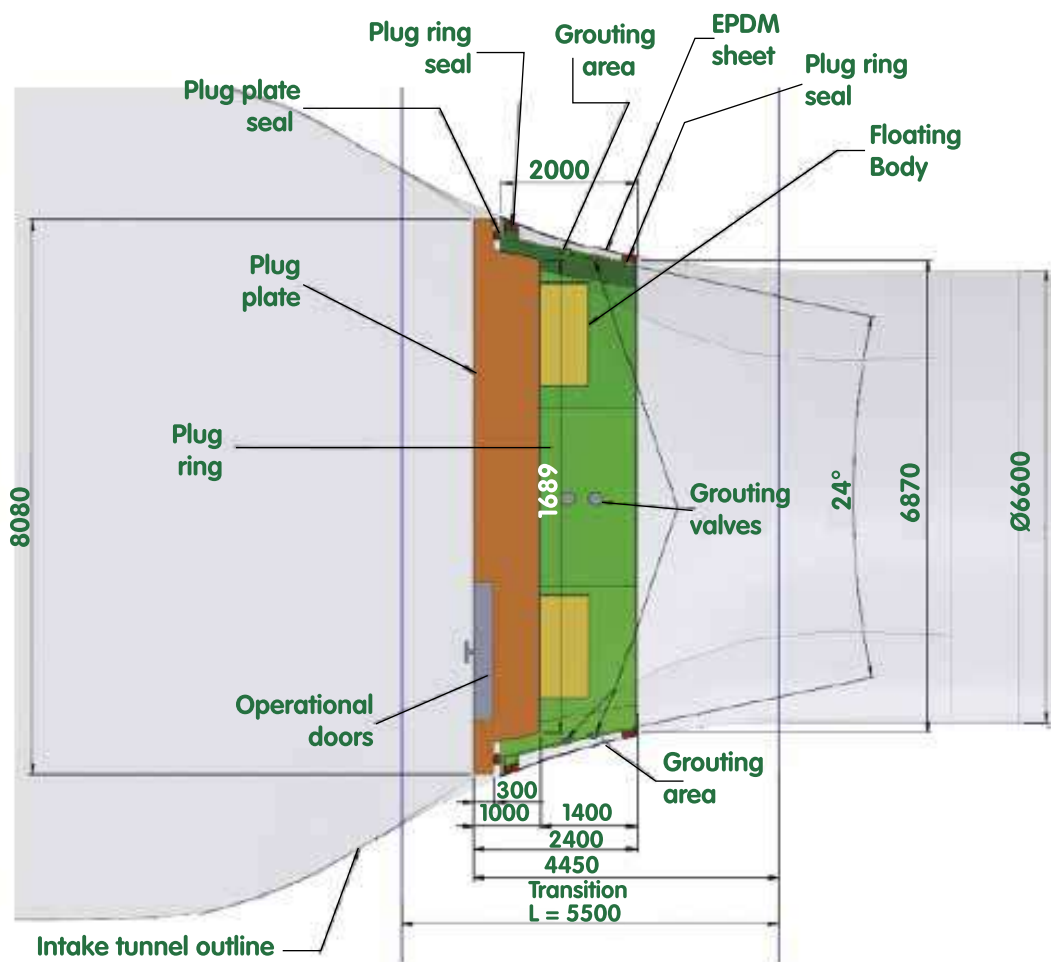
Esquema Mamparo mecánico propuesto por DCN (elevación longitudinal, medidas en mm). Recuperado de: (DCN Diving BV, 2021)
